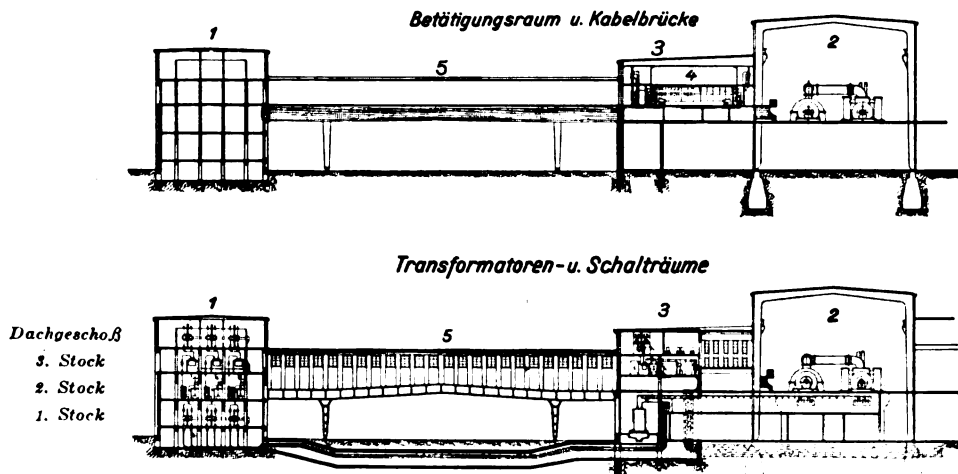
Querschnitte durch Maschinenhaus und Schalthäuser.
